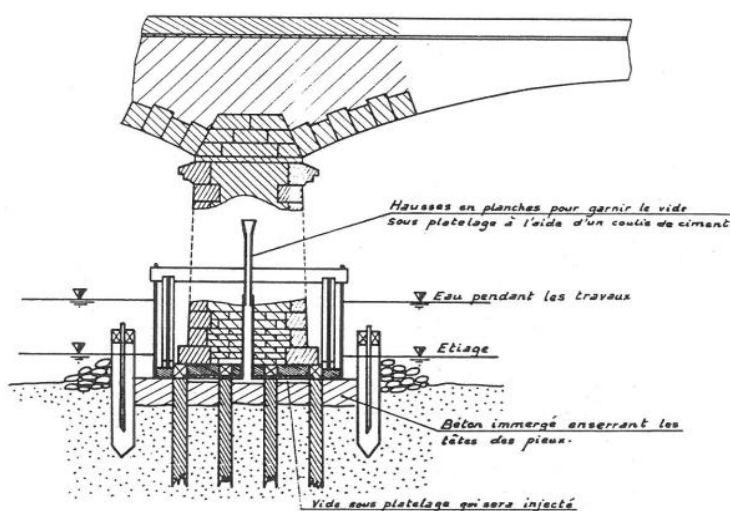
Coupe des fondations sur pieux enserrés dans un massif en béton immergé et emploi d'un caisson immergé - pont de Belle-Croix (Levillain, 1980)
